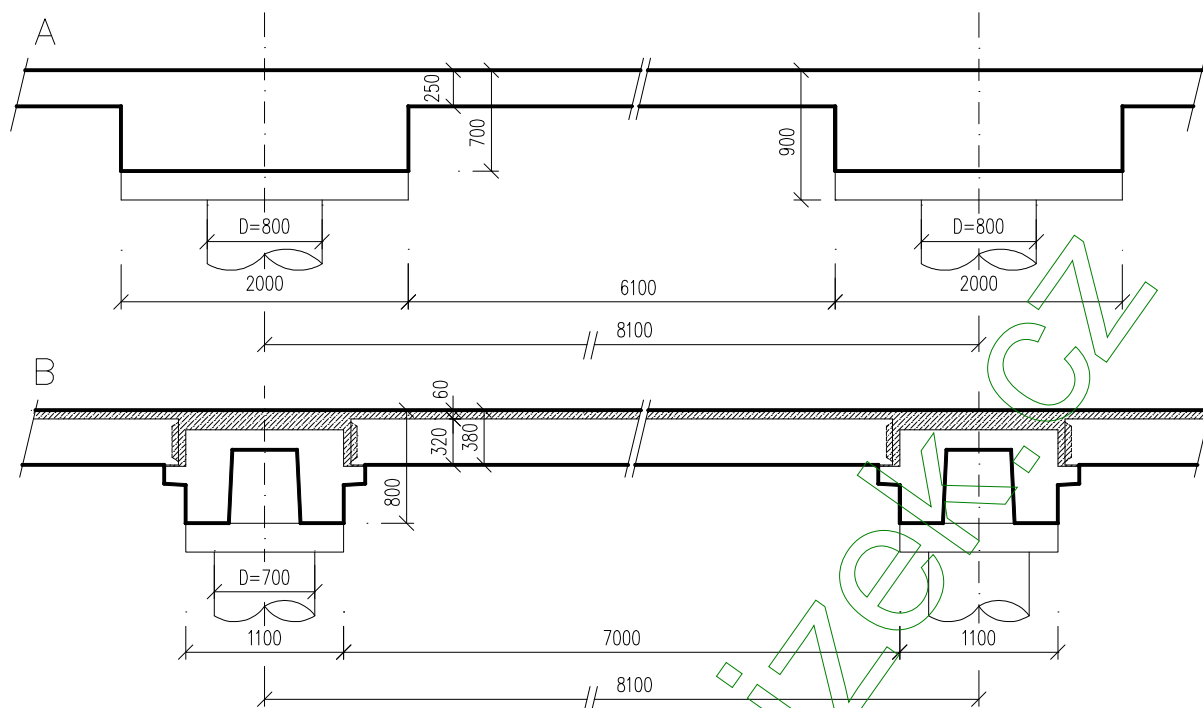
Finanční úřad v Mostě - skladba stropu 3. podlaží stropní konstrukce
